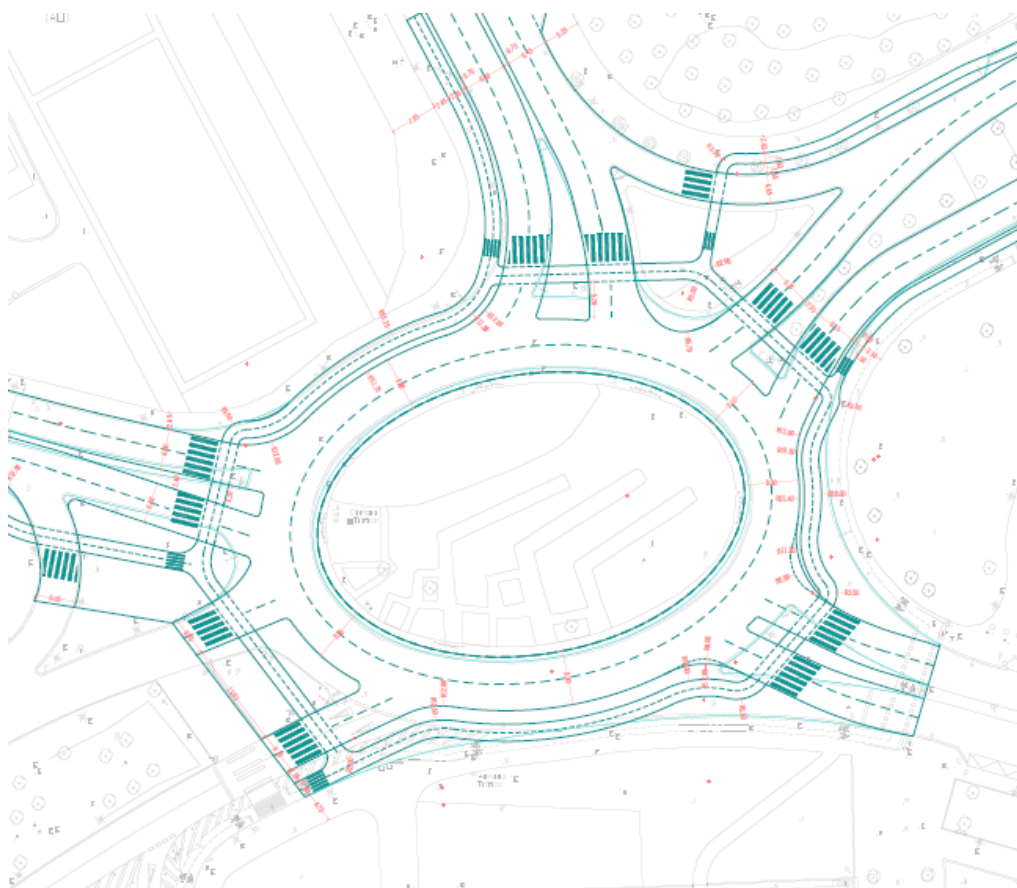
Detalle de la propuesta de solución de la red ciclista en la rotonda Bremen-Los Huetos-Urteaga
